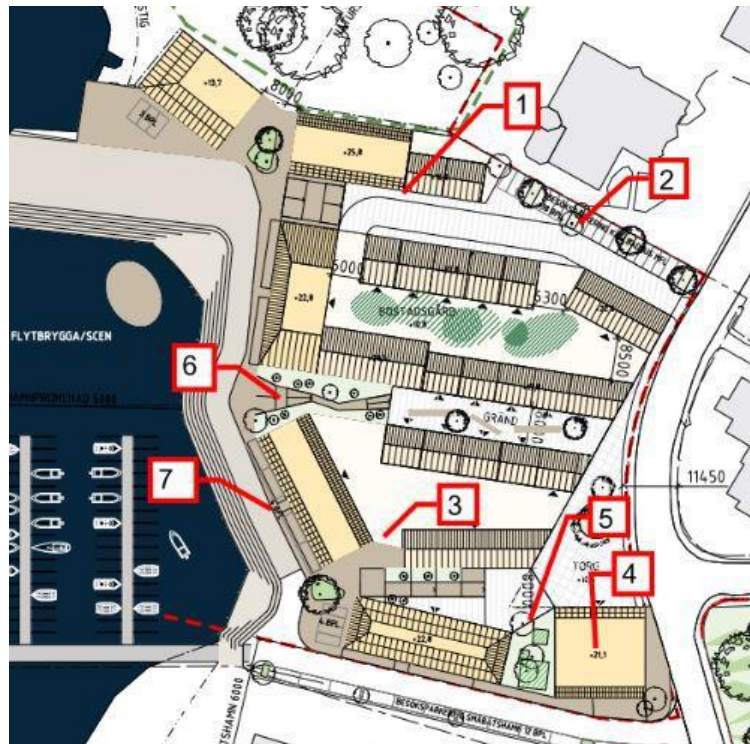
Förslag på dagvattenhantering inom planområdet. 3=Uppsamlingsdammar/raingardens, 6=Fördröjning/avledning vid trappor, 8=Anslutning befintligt dagvattennät.
